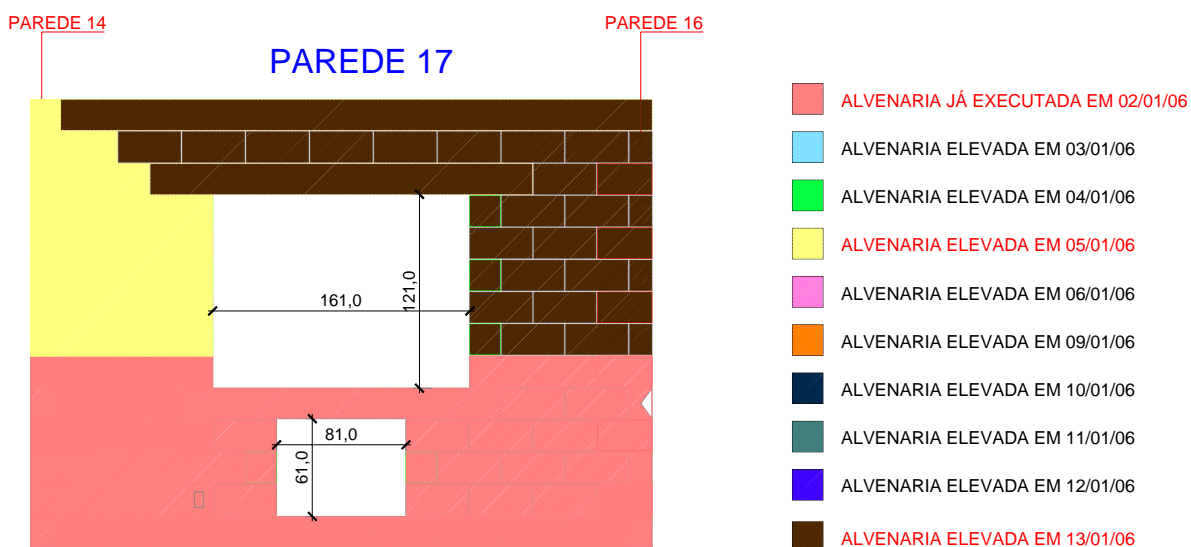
Elevação da parede 17 (controle de produção do serviço de elevação)
